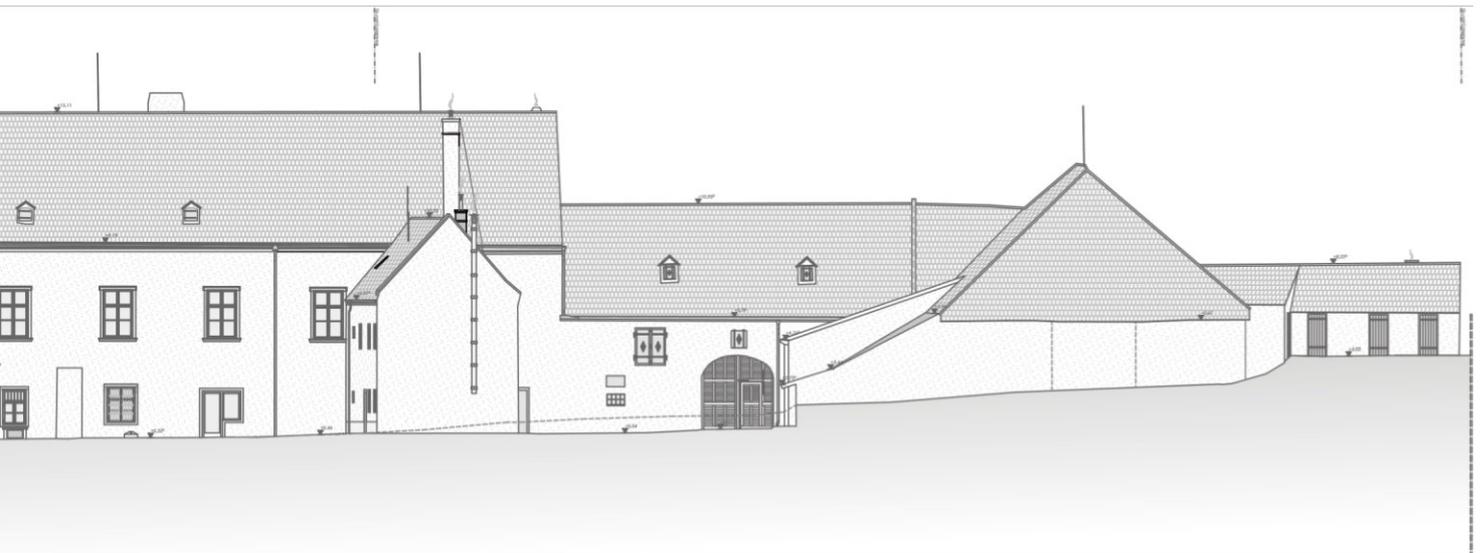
Bestandsplan Ansicht Süd- Übersichtsplan
